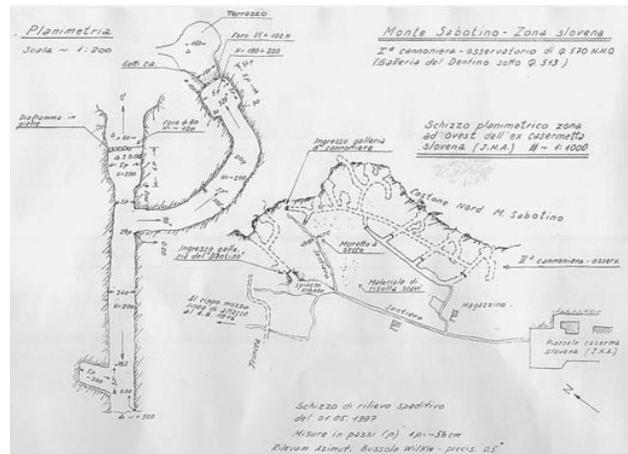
Schizzo planimetrico speditivo, eseguito da Stefano Bressan il 01.05.1997, della zona in cui si trova la "Galleria delle 8 cannoniere" con la rappresentazione in pianta della vicina "Galleria del Dentino".
